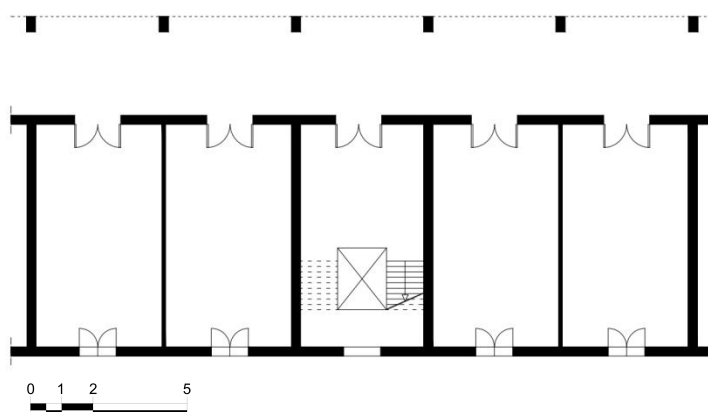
Piano terra B edificio con negozi - elaborazione dell'autore
